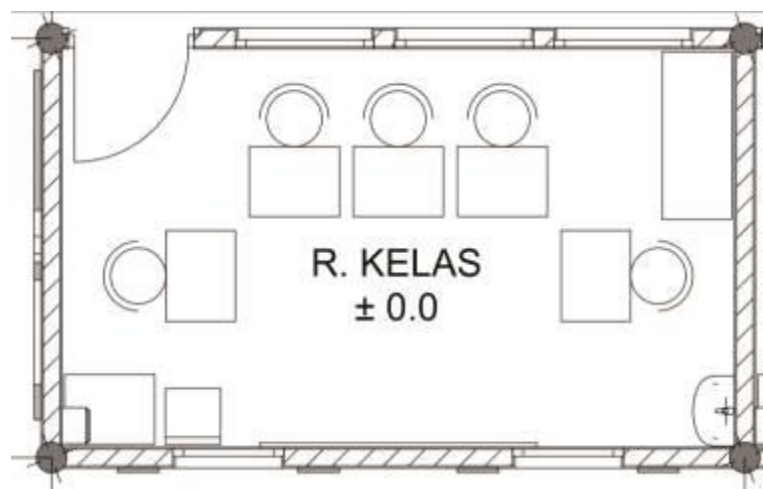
33 Layout Ruang Kelas Autis Saat Ini
